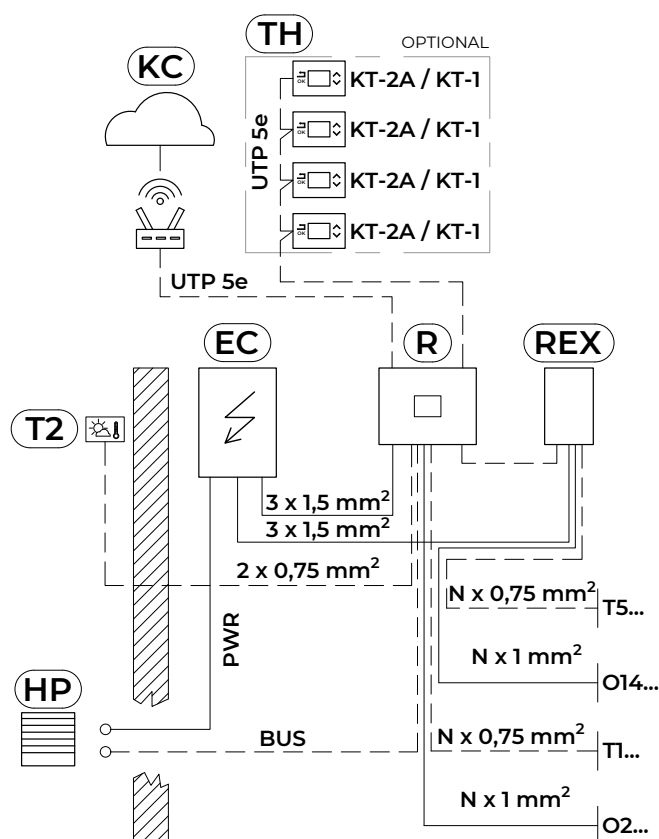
Elektrisches Anschlussschema ADAPT MAX
